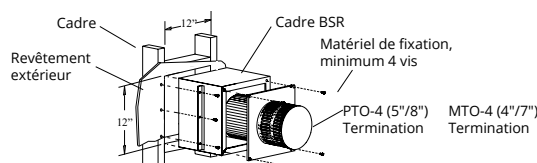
c Installation d'un chapeau MTO avec le cadre BSR.
